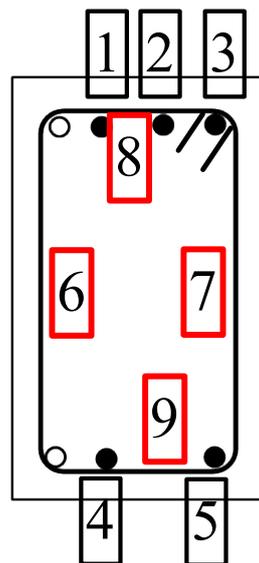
SH/SLB 梁試體應變計配置圖(黑框表示配置於主筋，紅框表示配置於箍筋)
